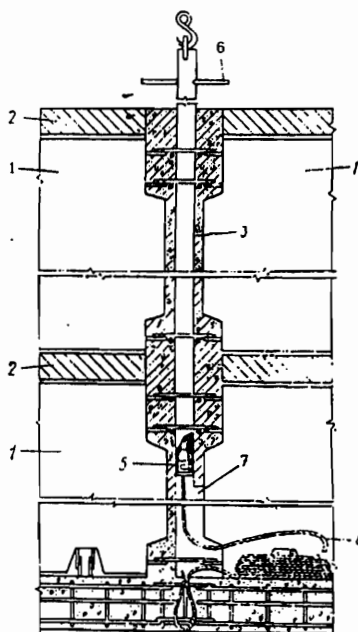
Укладка вертикальной канатной арматуры с помощью трубы-каналообразователя: 1 – внутренняя стенная панель; 2 – плита перекрытия; 3 – труба-каналообразователь; 4 – канатная арматура; 5 – цапговым захват; 6 – рычаг; 7 – окно
